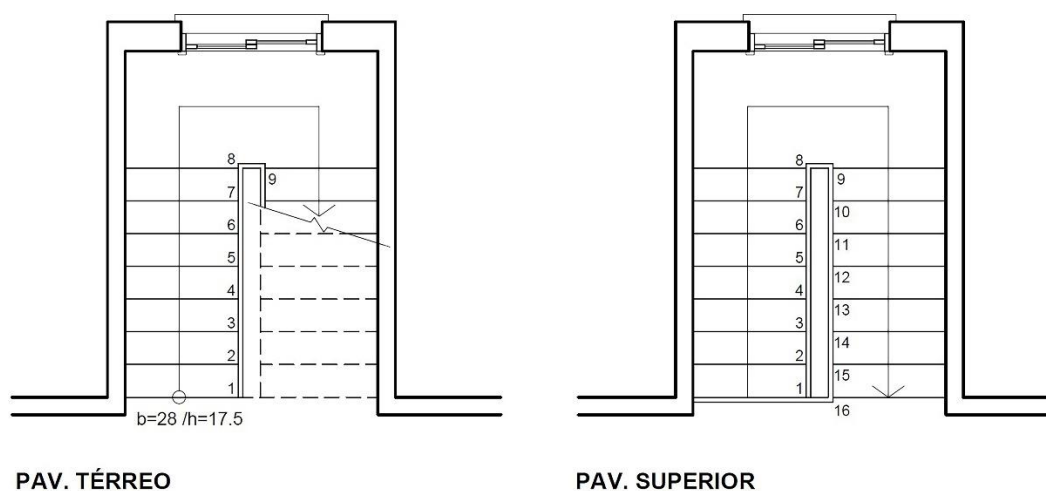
4º passo na representação de uma escada em planta baixa. Fonte: autor
